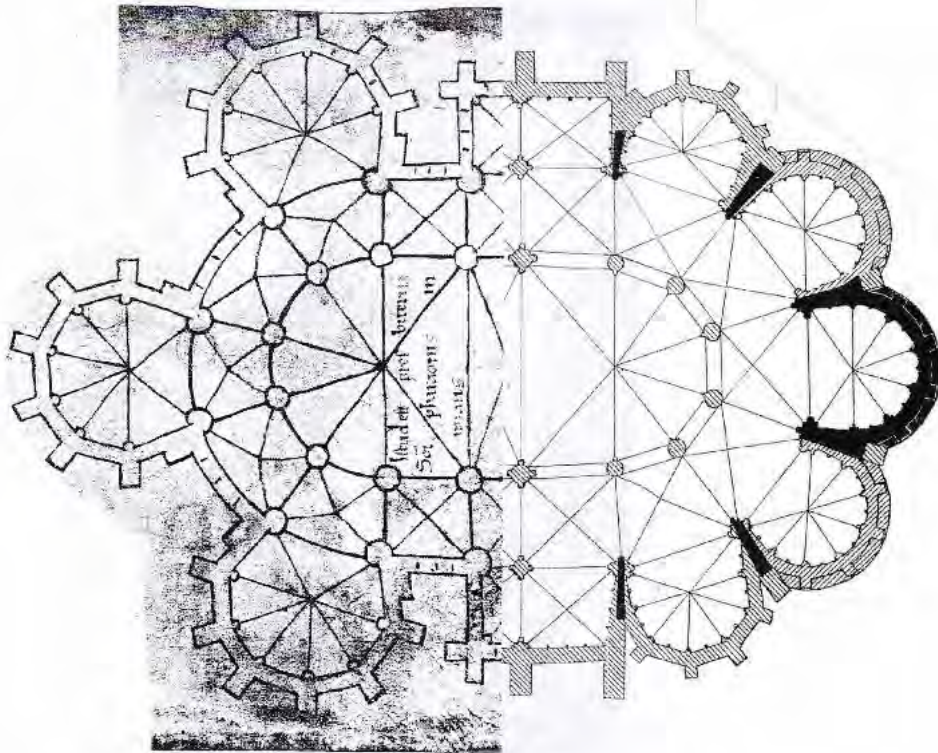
Meaux : montage du plan par Villard et par P. Kurmann.
